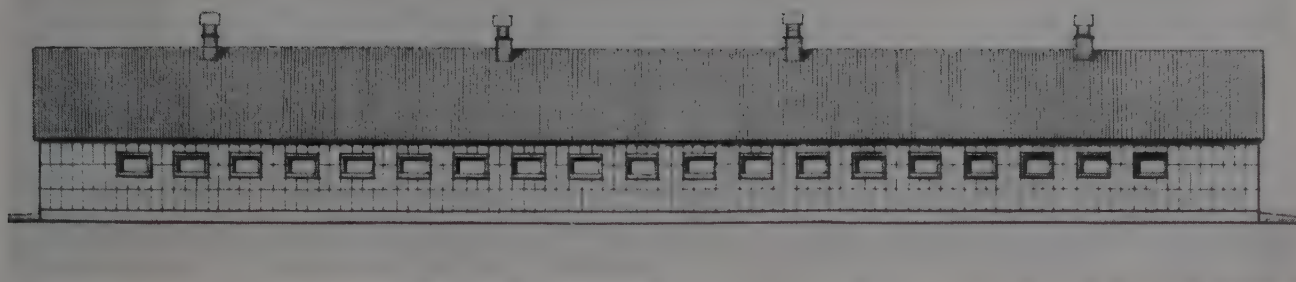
Schweinemaststall für 200 Schweine – Nordansicht
